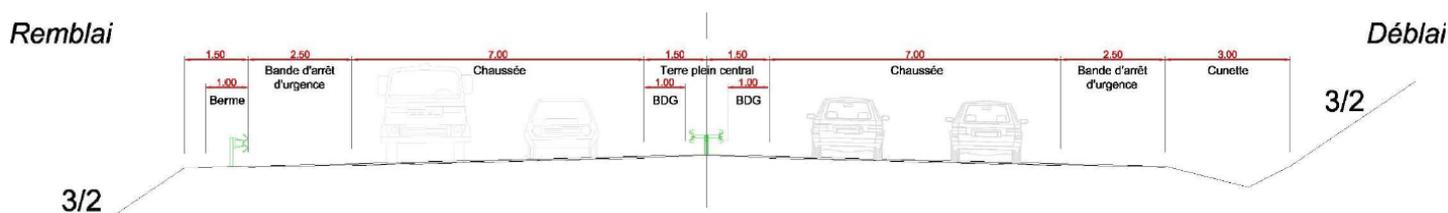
Profil type de l'aménagement prévu en section à 2x2 voies (source : étude d'impact)
